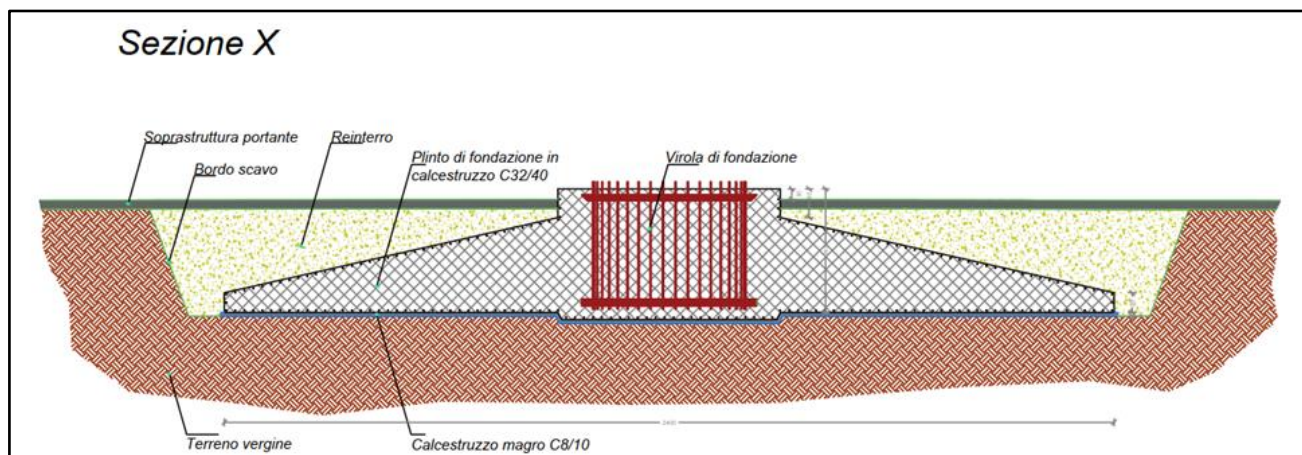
Sezione di progetto della fondazione per l'aerogeneratore NORDEX N163/5.X
